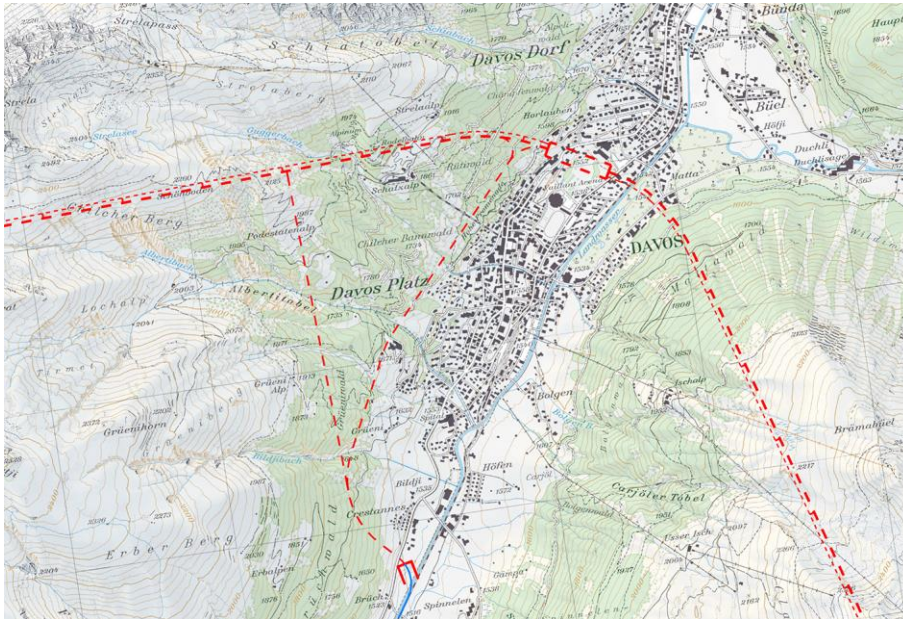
4 Ausschnitt Situationsplan, Bereich Davos
